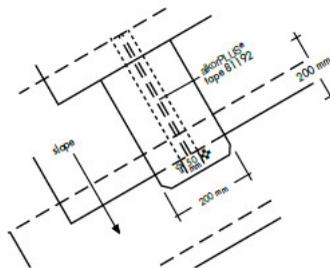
Figure B Aluminium-Klebeband – Bereich ohne Verschweißung
